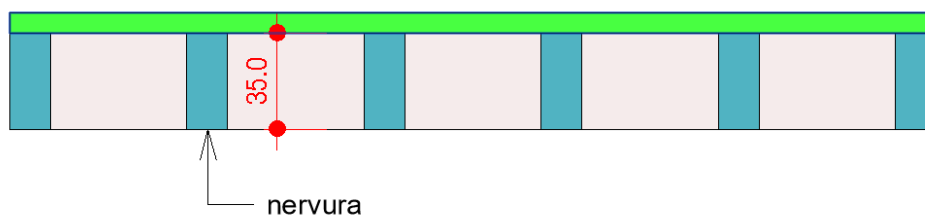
Vista inferior laje nervurada lisa bidirecional – dimensões da cubeta plástica
